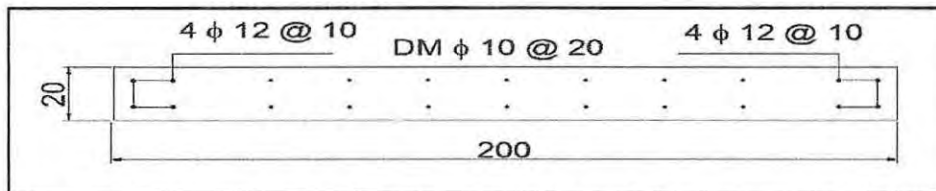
Armadura de flexo-compresión Muro 2, Estructura III (Aislada).
